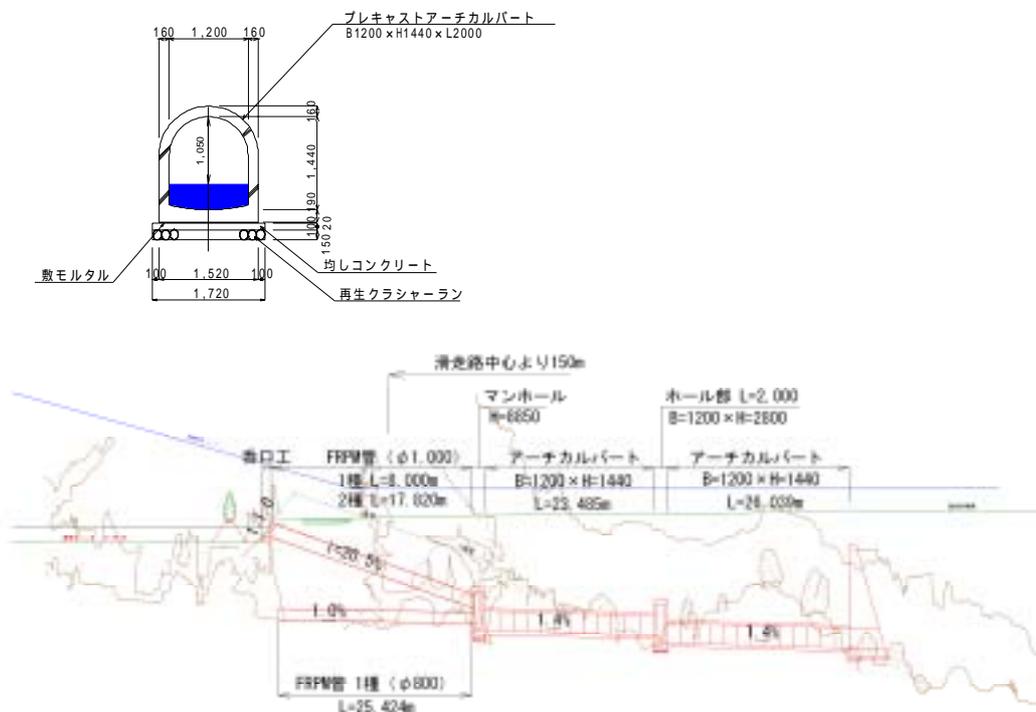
C 1 洞の空洞対策工縦断面図及び標準断面図
